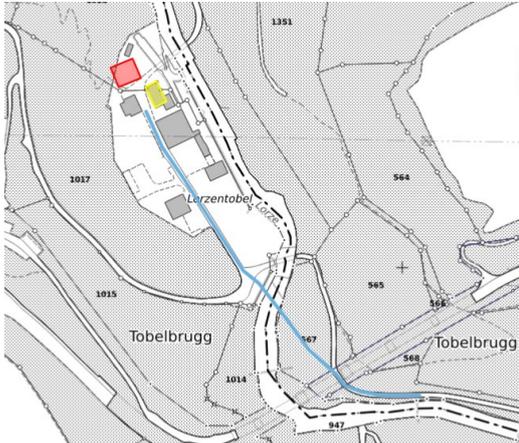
Standort der neuen Zentrale im Gebiet Lorzentobel: rot = neue Zentrale, gelb = Abbruch Lagergebäude, blaue Linie = geplante Baustellenzufahrt mit temporärer Hilfsbrücke (Grundbuchplan; 3D Ansicht ZugMap; Lage des neuen Gebäudes schematisch)
